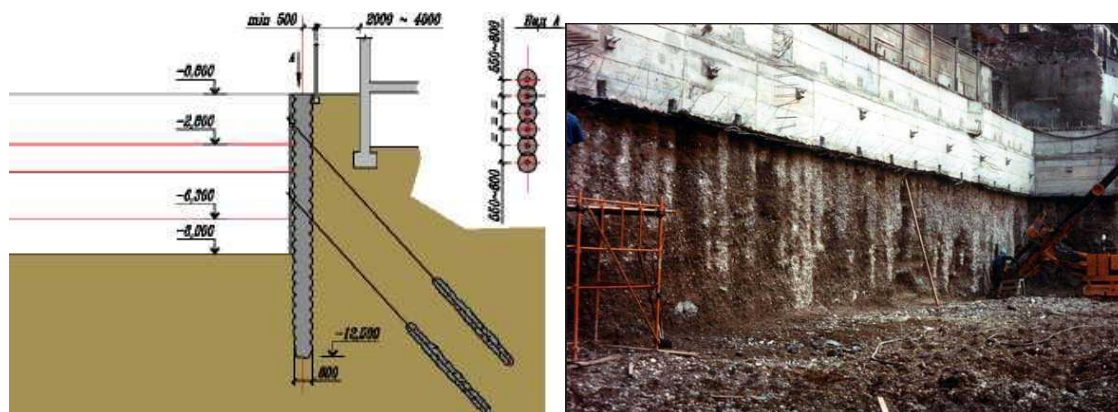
Огородження котловану з ґрунтоцементних пересікаючихся паль-колон на будівництві нульового циклу нової офісної будівлі в Мілані (зліва принципове рішення, справа процес улаштування другого ярусу анкерів)
